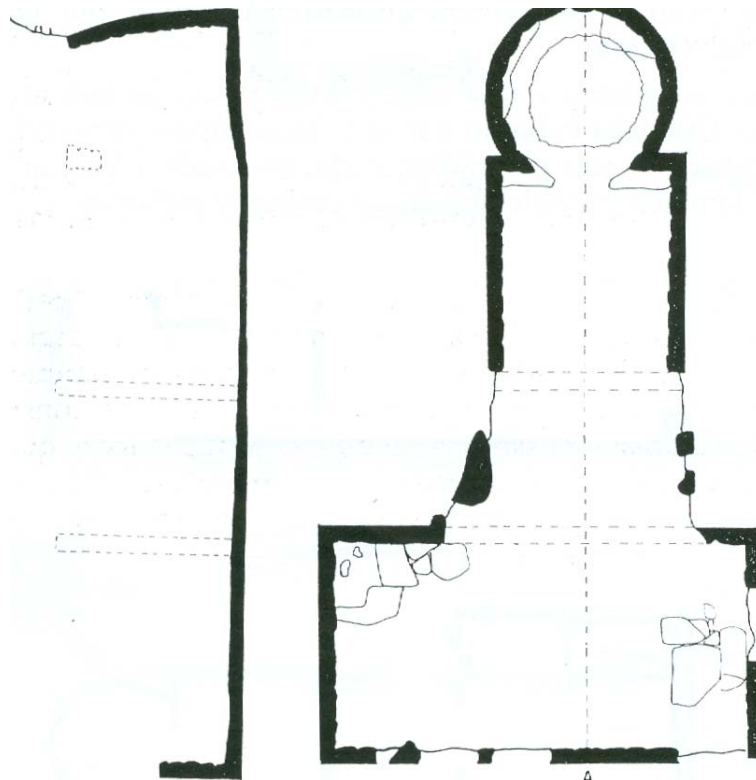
Planta y alzado de la «sauna» de Monte da Saia (Silva, 1986).
